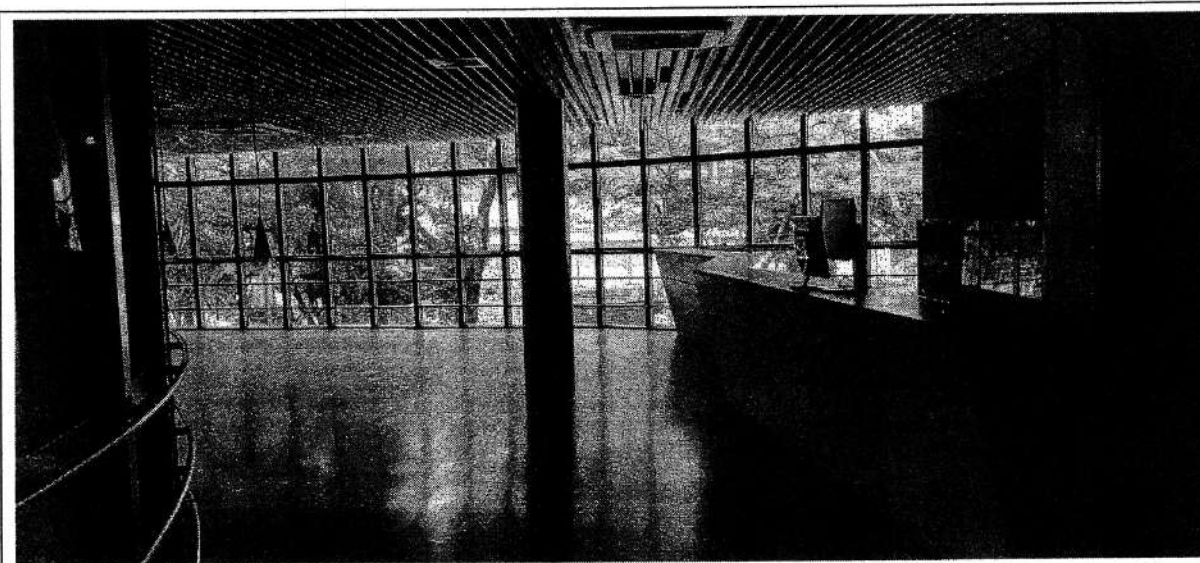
2º pavimento – espaço destinado ao restaurante/café. Balcão de atendimento não acessível
